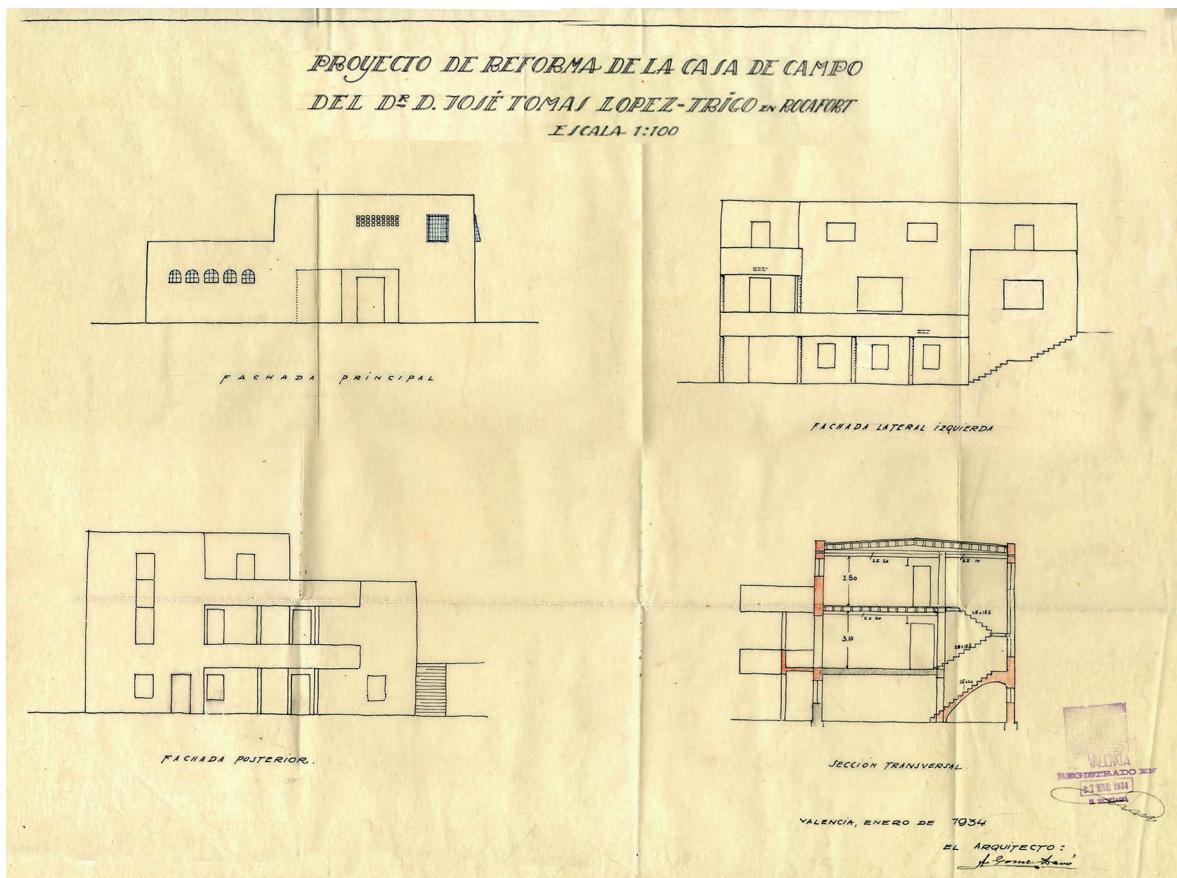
Antonio Gómez Davó, casa López-Trigo, Rocafort, 1934, Plano de alzados y sección E: 1/100, Tinta y lápiz de color sobre papel vegetal.
